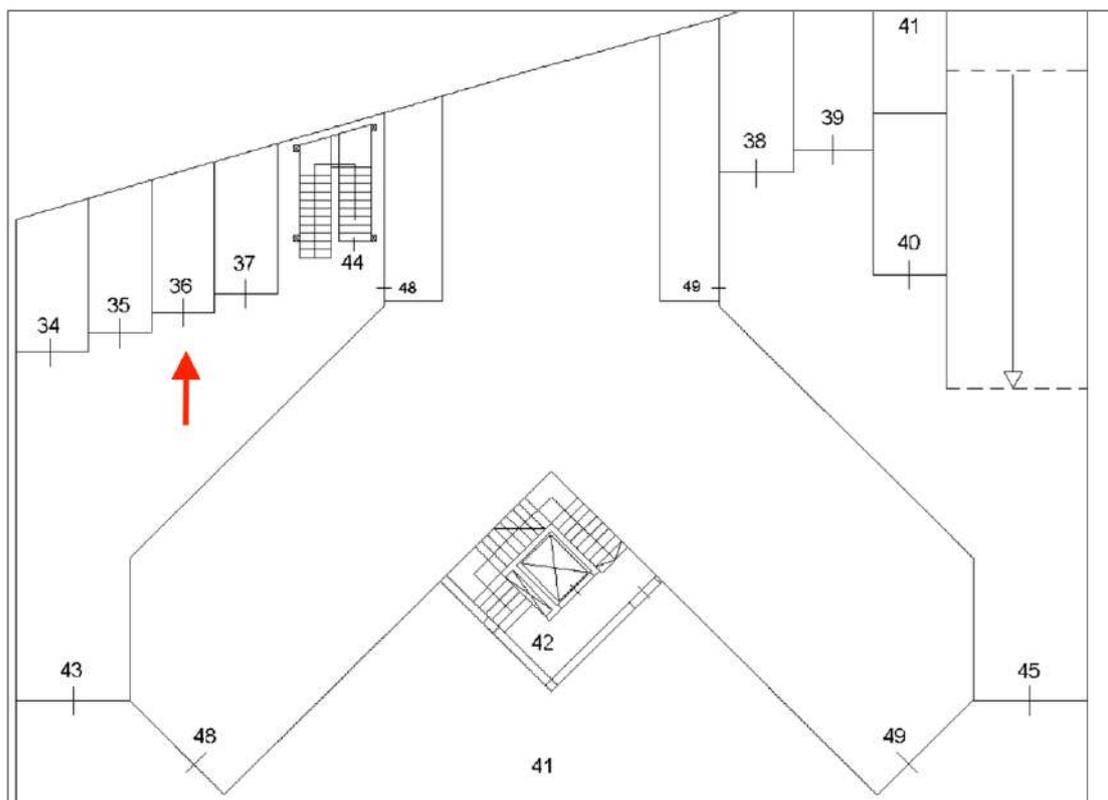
Stralcio pianta piano terra dell'elaborato planimetrico catastale: localizzazione posto auto scoperto sub 36.
